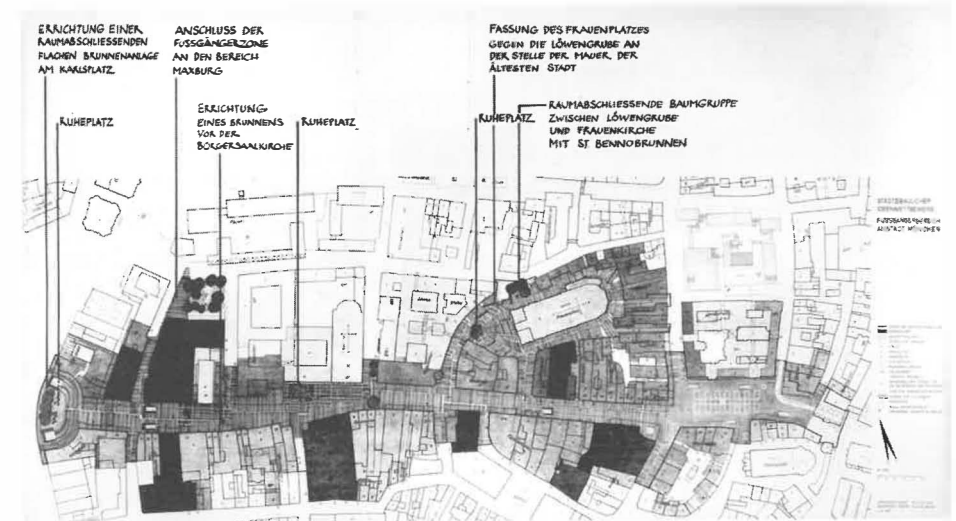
Städtebaulicher Ideenwettbewerb – Plan 1. und 4. Preisträger.
